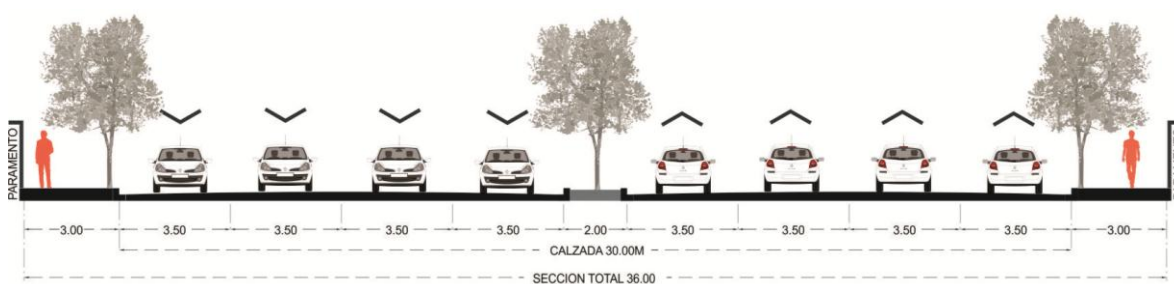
Sección Vialidad Primeria 36m.
